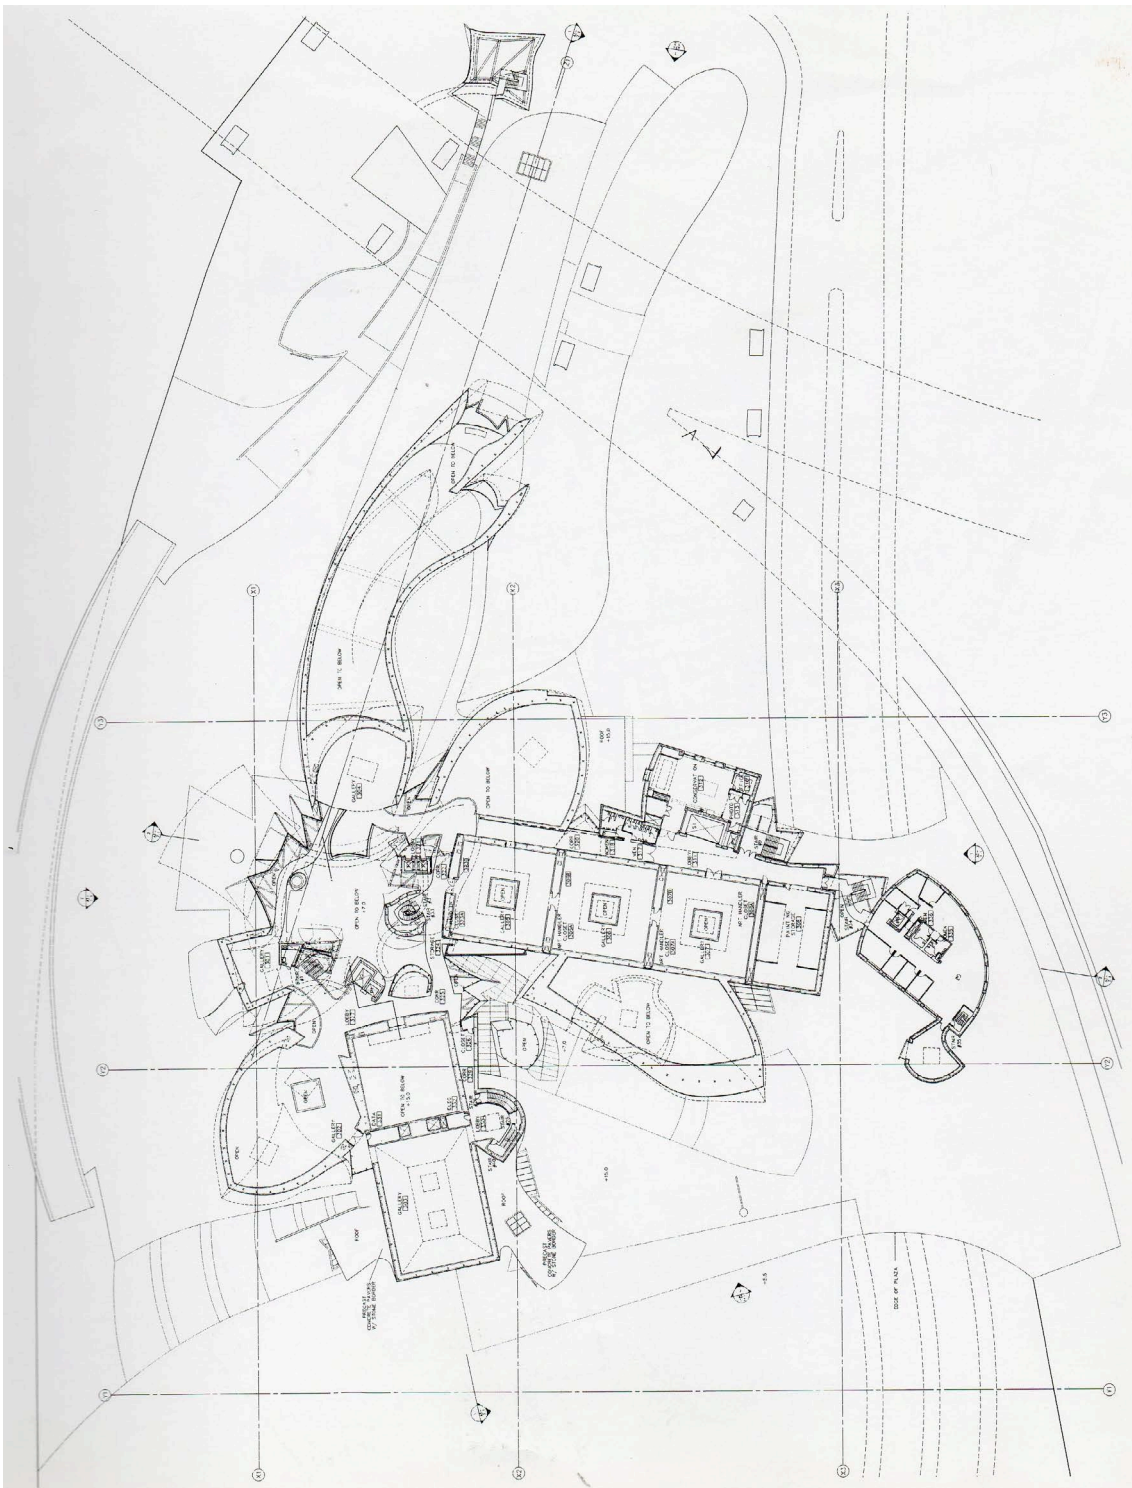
Frank Gehry, Ausführplan Guggenheim Museum, Grundriss 3. Geschoß
